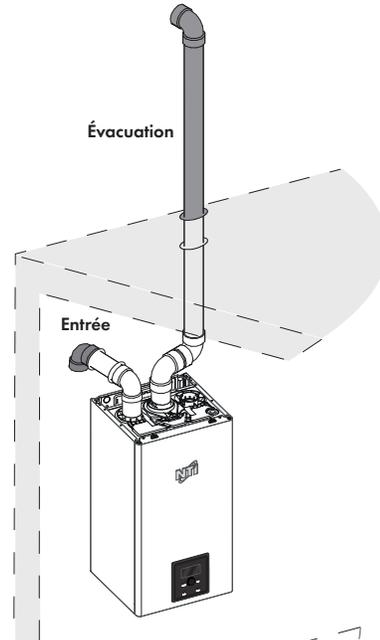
Ventilation non équilibrée - Évacuation de toit et entrée latérale
